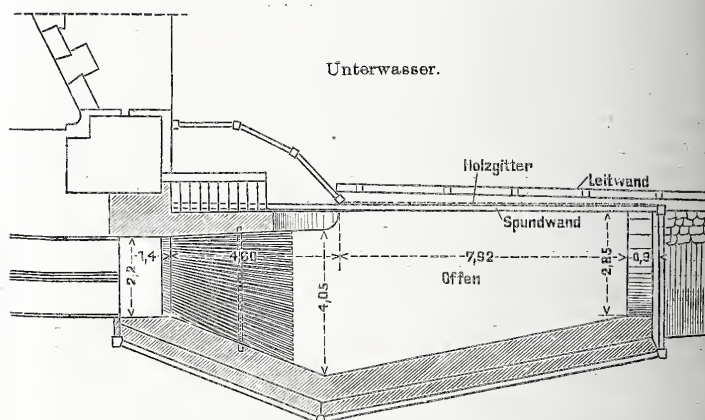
Grundriß der unteren Ausmündung mit Rechenwehr.
